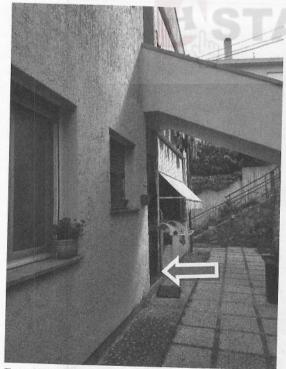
Vista della corte comune, antistante Foto N°6. Vista del terrazzo antistante l'ingresso l'ingresso alla abitazione al Piano terra.
